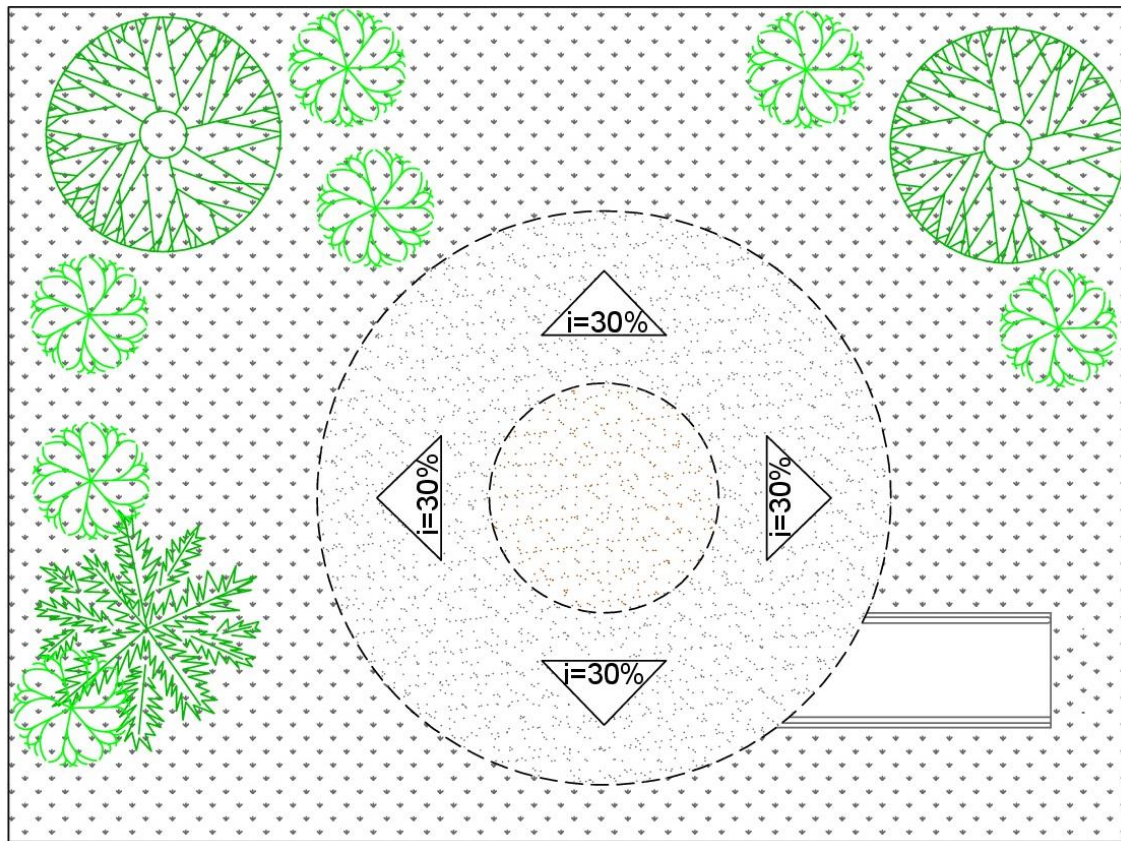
Planta de Cobertura Centro de Apoio - Por Eloísa Bussi Fernandes
